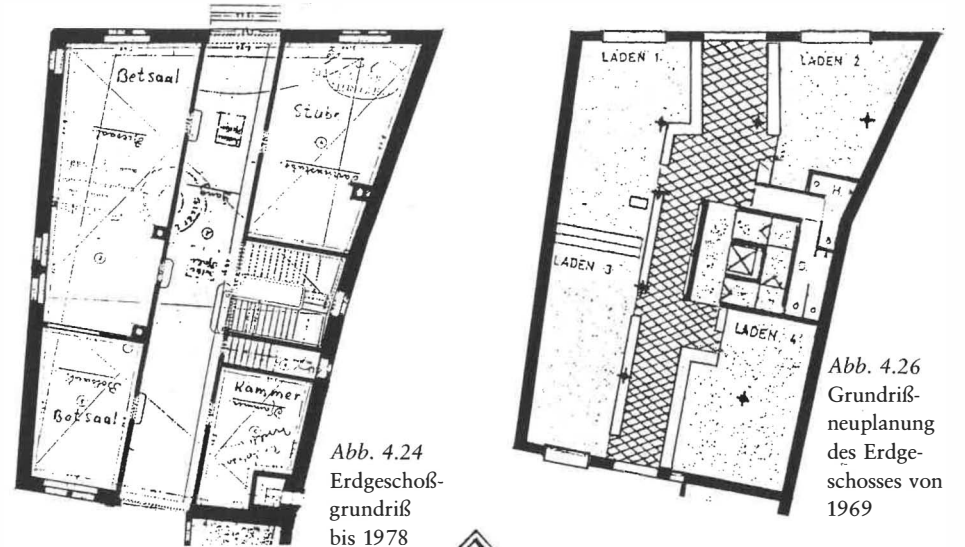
Erdgeschoßgrundriß bis 1978
